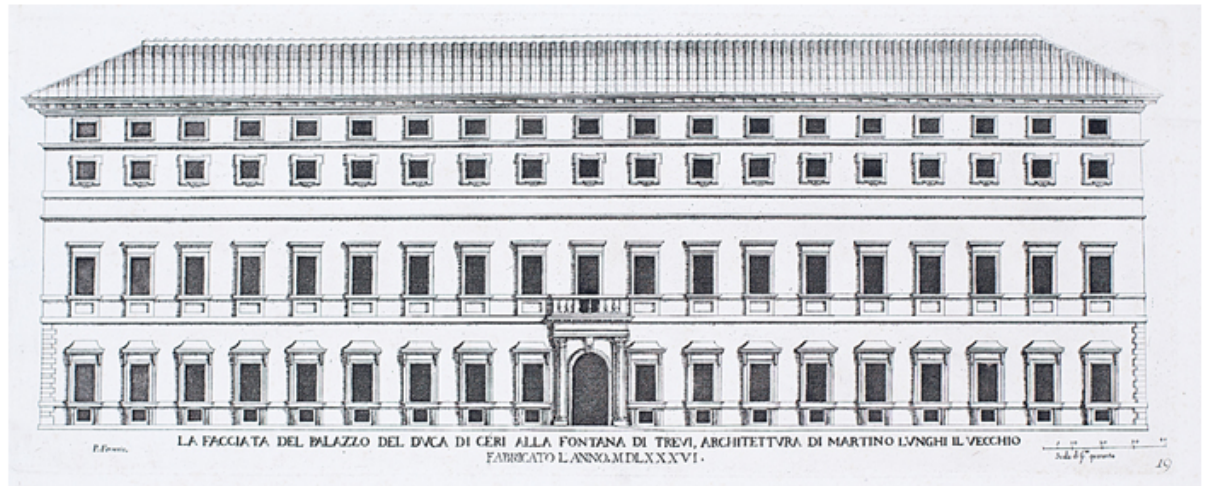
Pietro Ferrerio, *Facciata e pianta del palazzo Ceri-Poli*, XVII secolo.
